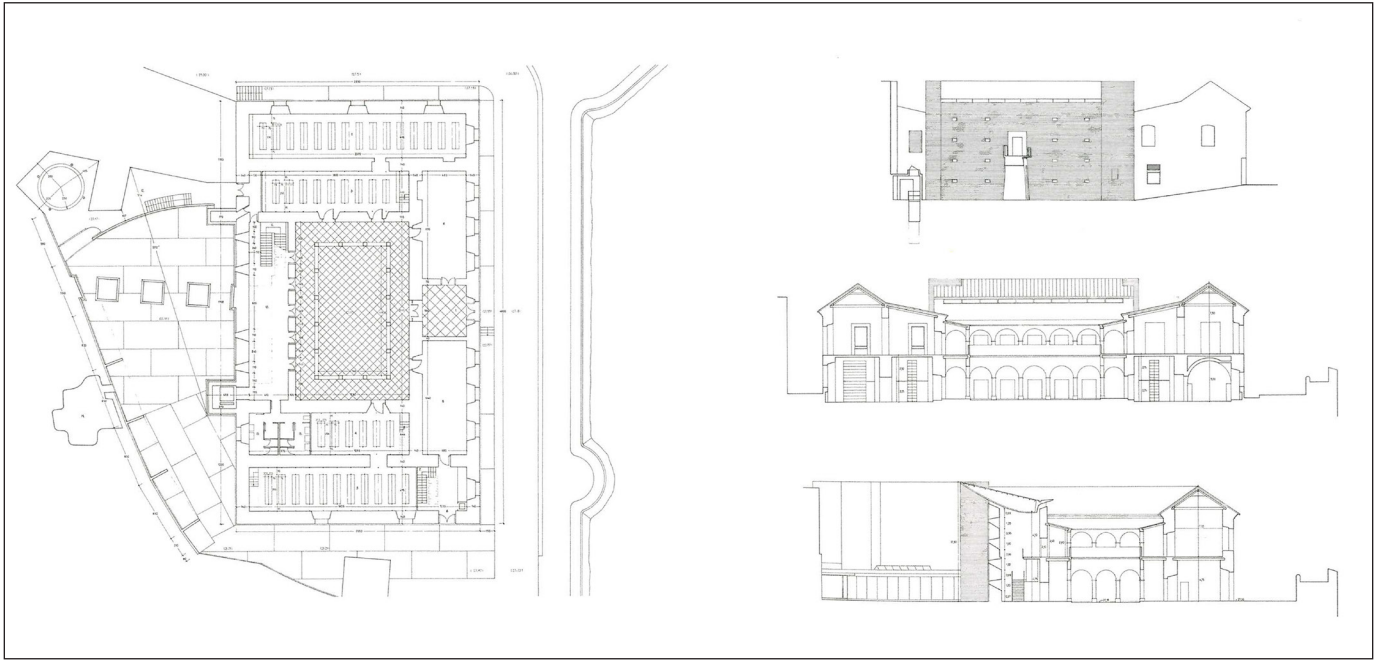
Melilla, Hospital del Rey, pianta del piano terra, prospetto meridionale, sezione longitudinale e trasversale (da «DiseñoInterior», 1997).
